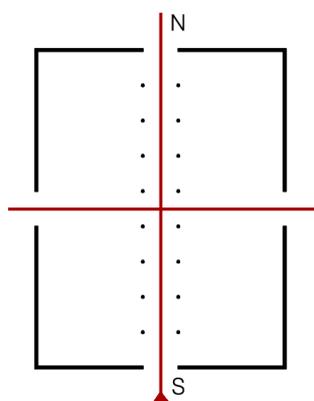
Planta esquemática: eixos estruturantes
